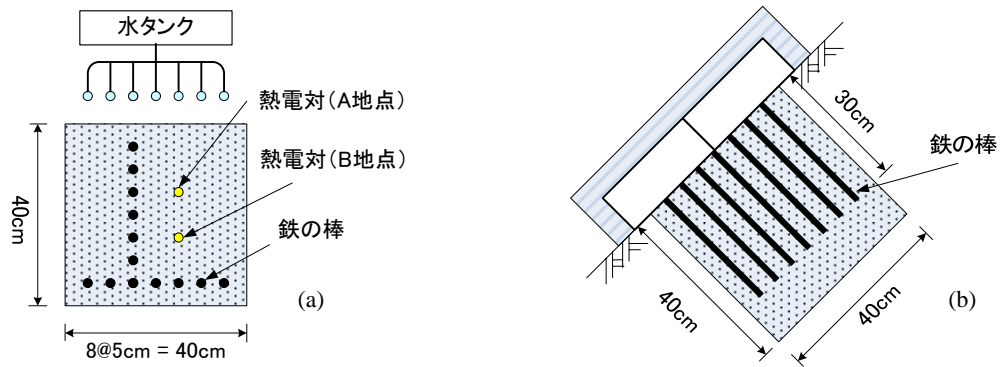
地盤凍結実験3 (a)平面図 (b)断面図
